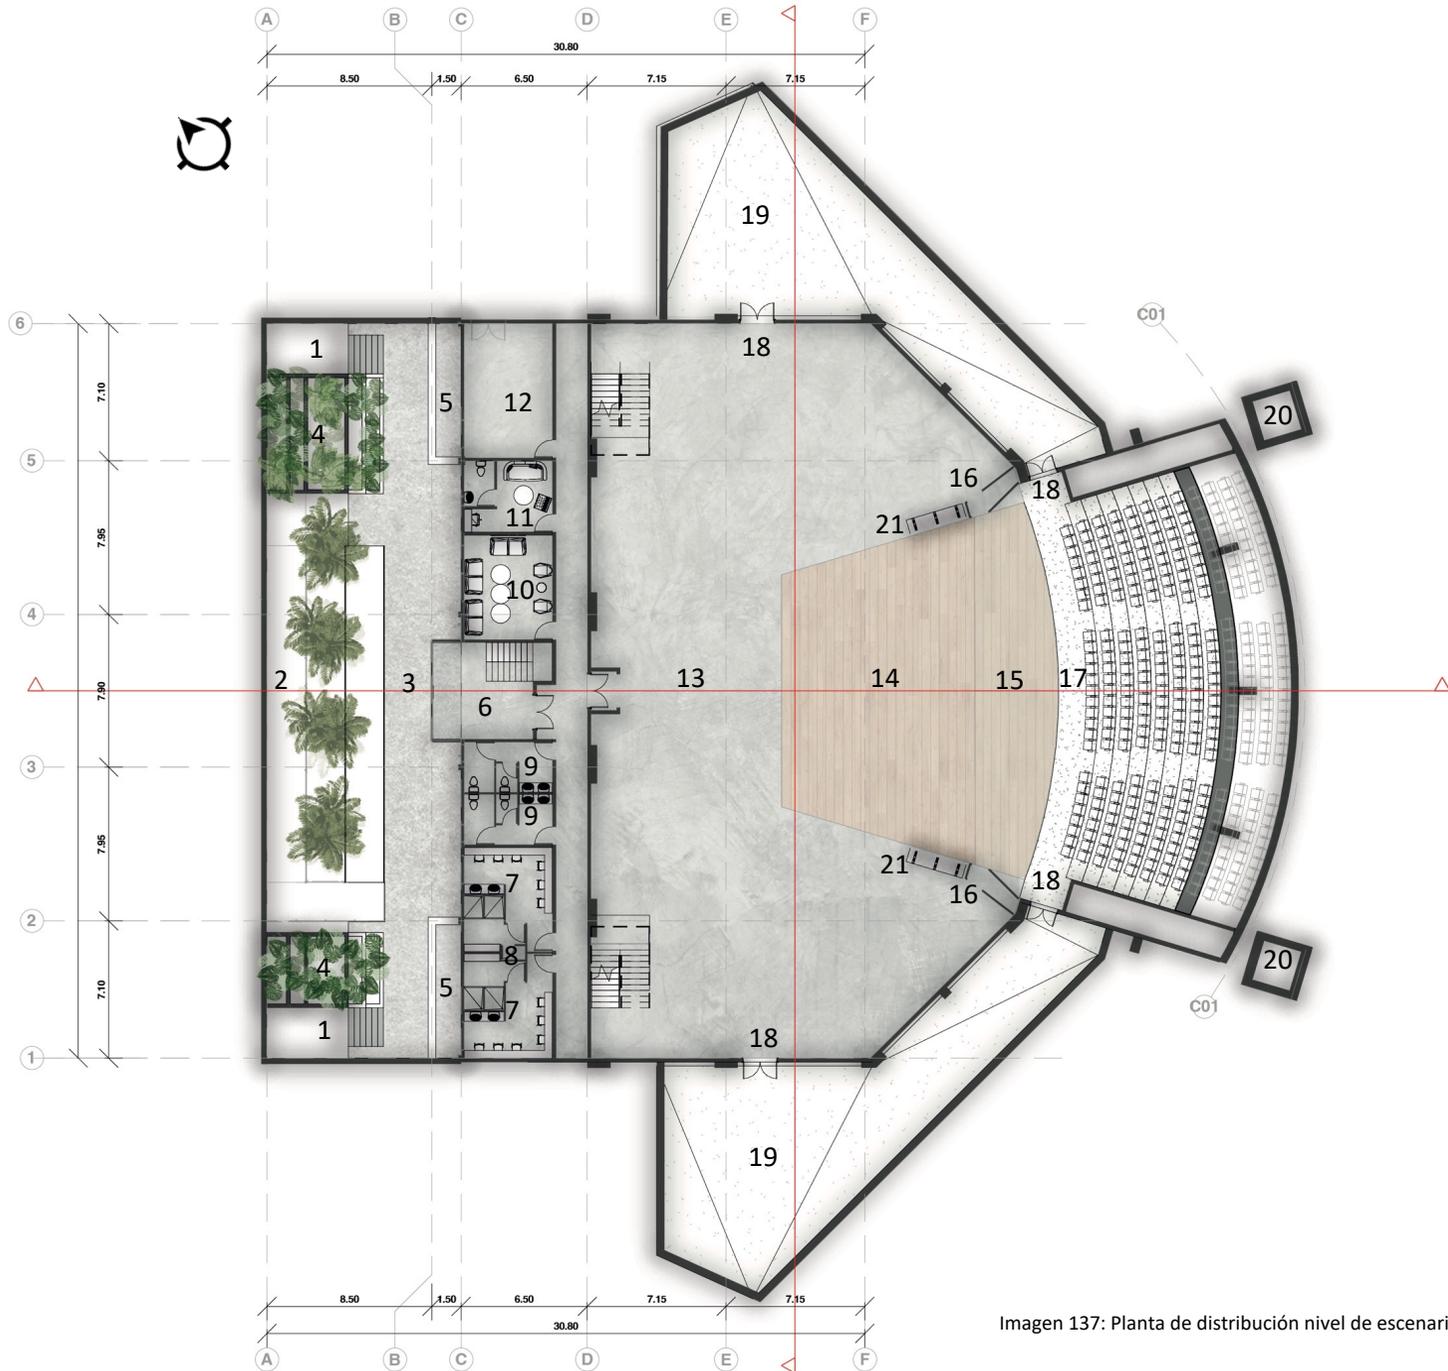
Planta de distribución nivel de escenario NPT -3.40 m
